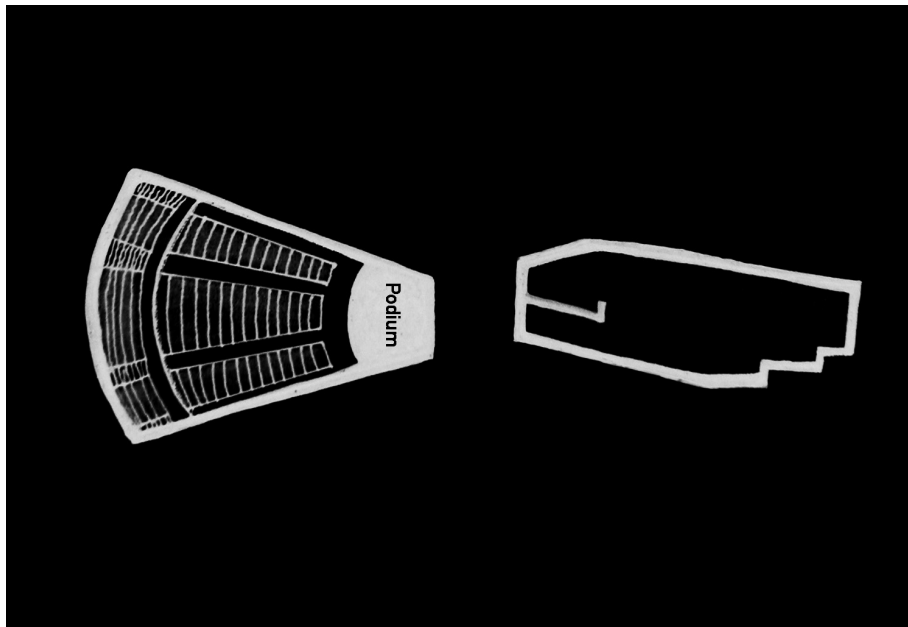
Fächer-Saalform (Grundriss, Längsschnitt). Skizzen: Sian Brehler, 2006.
